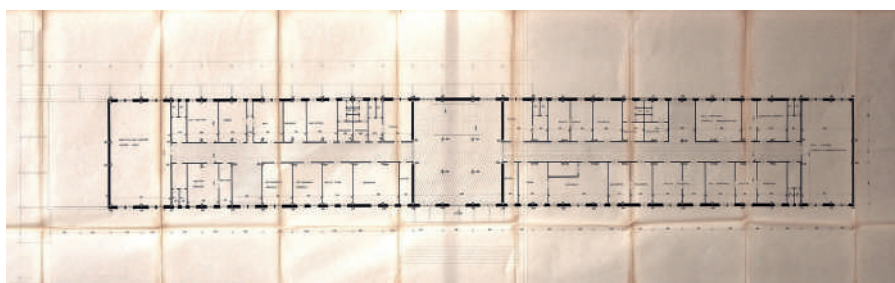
Raffaele Argo, Progetto di completamento e ristrutturazione dell’Ospedale, 2° lotto. Monoblocco A, primo piano. Pianta, scala 1:100, 20 marzo 1972 [da AOAPPCNa].
